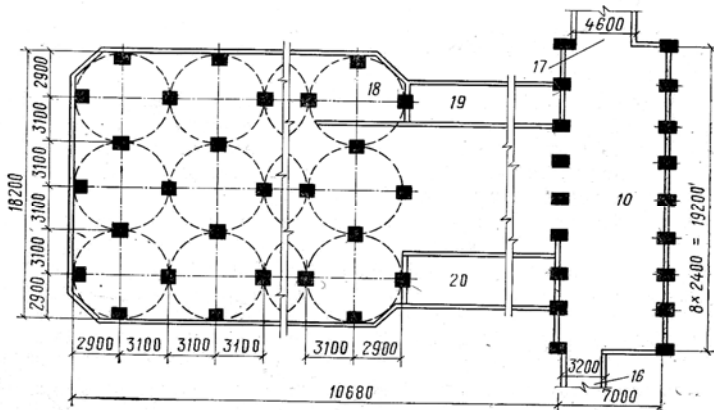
Монолітний залізобетонний елеватор з круглими колонами:
